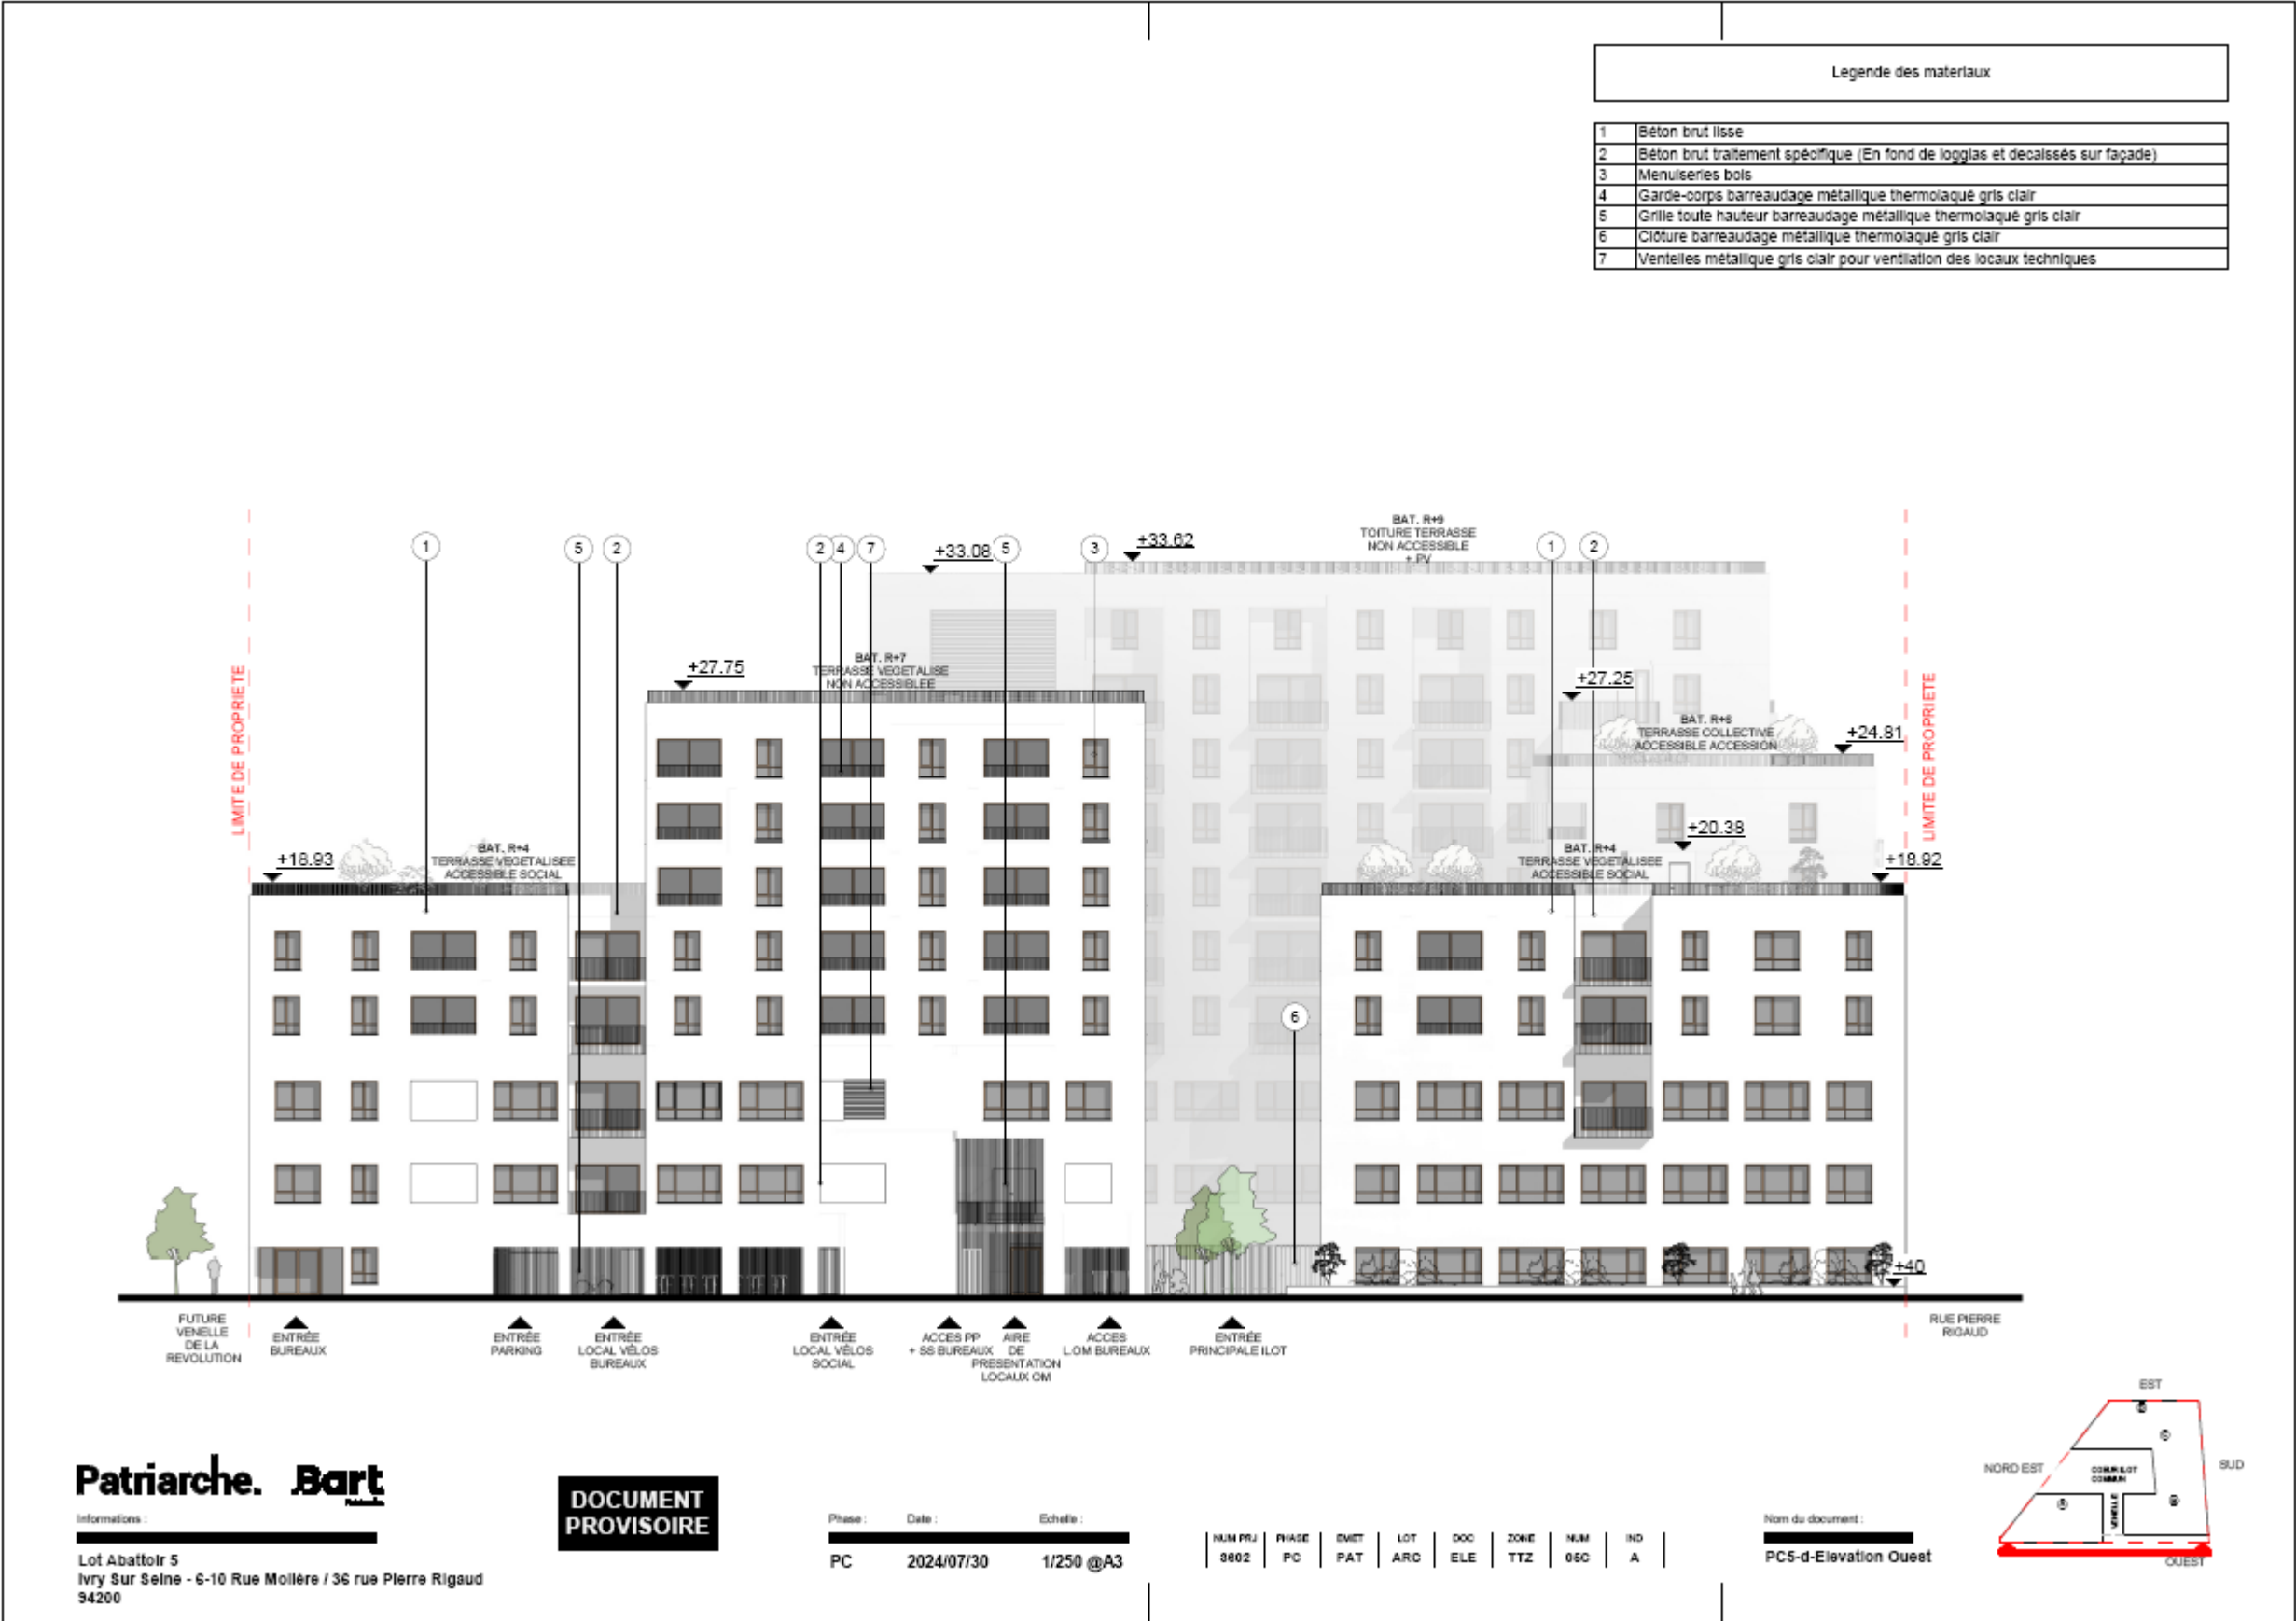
Coupe élévation Ouest (Source : Plan du pré PC, Patriarche, Bart, juillet 2024)
